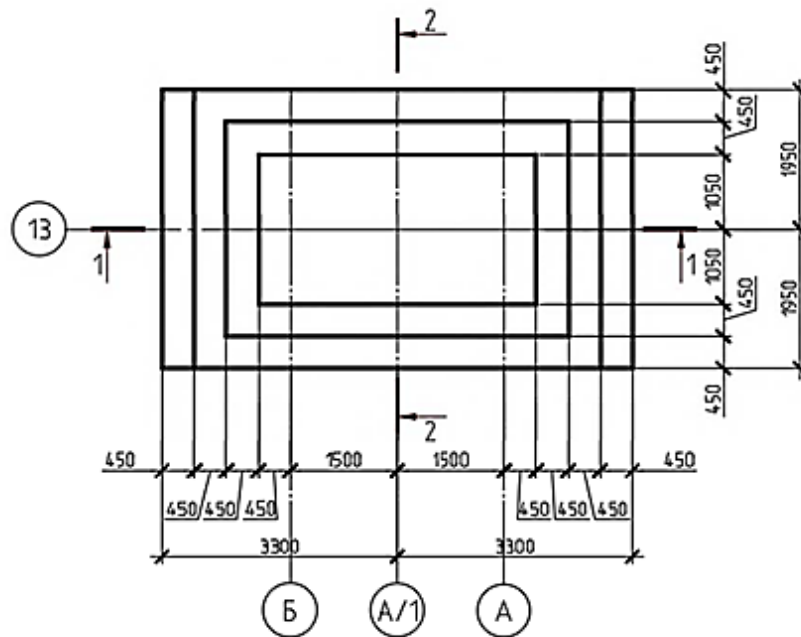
Опалубне креслення і армування фундаменту
